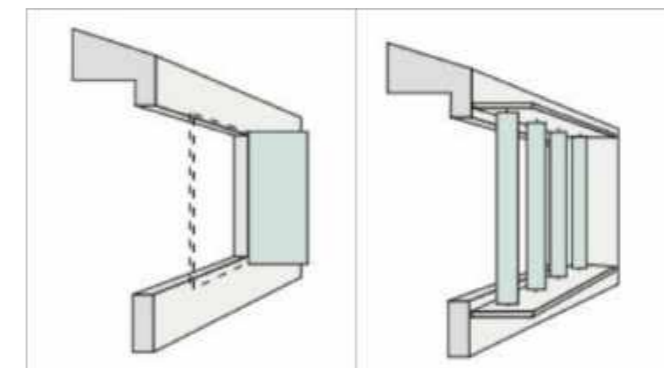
Protección solar con elementos verticales. Fuente: Elaboración propia.
